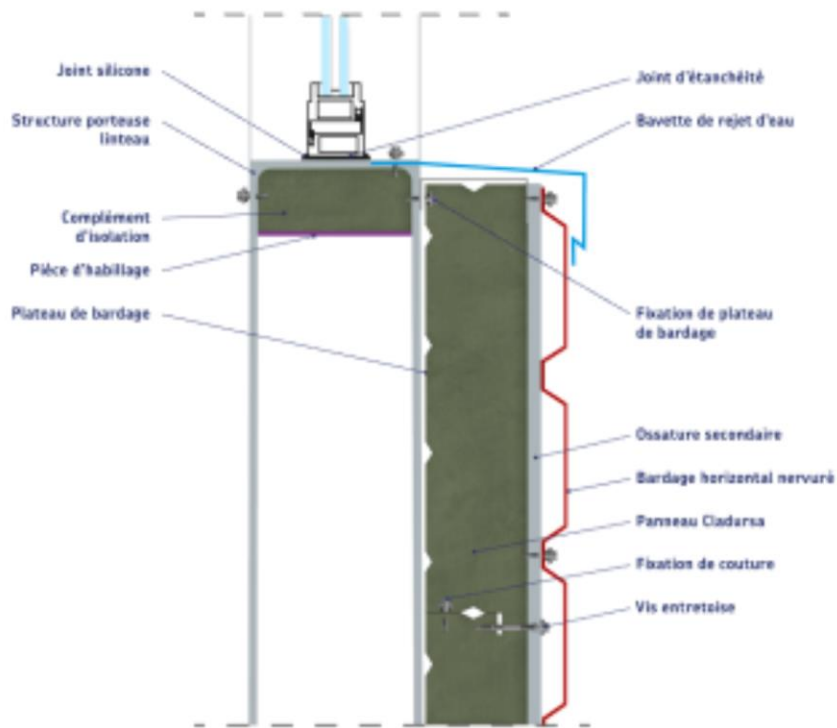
Coupe sur appui de baie - Exemple de solution avec ossature secondaire
